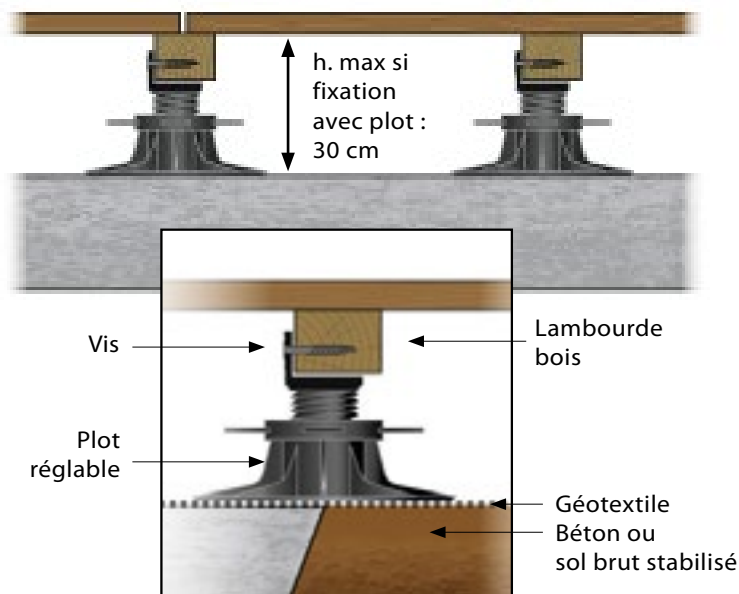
PLATELAGE (LAMES + LAMBOURDES) SUR PLOTS POLYMÈRE ET DALLE BÉTON
